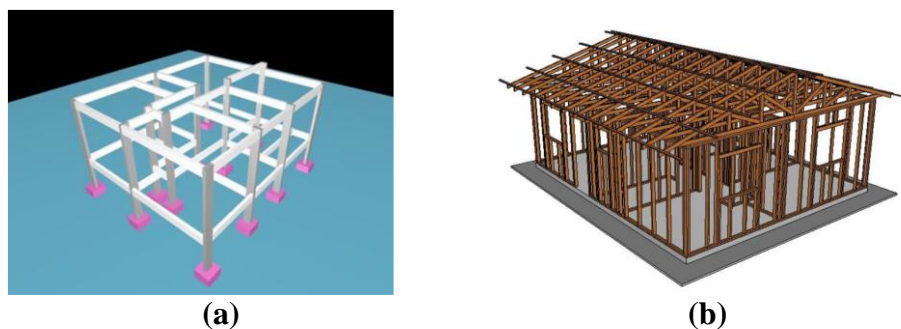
Soluções estruturais para o projeto padrão: (a) em concreto armado; (b) em Wood Frame
